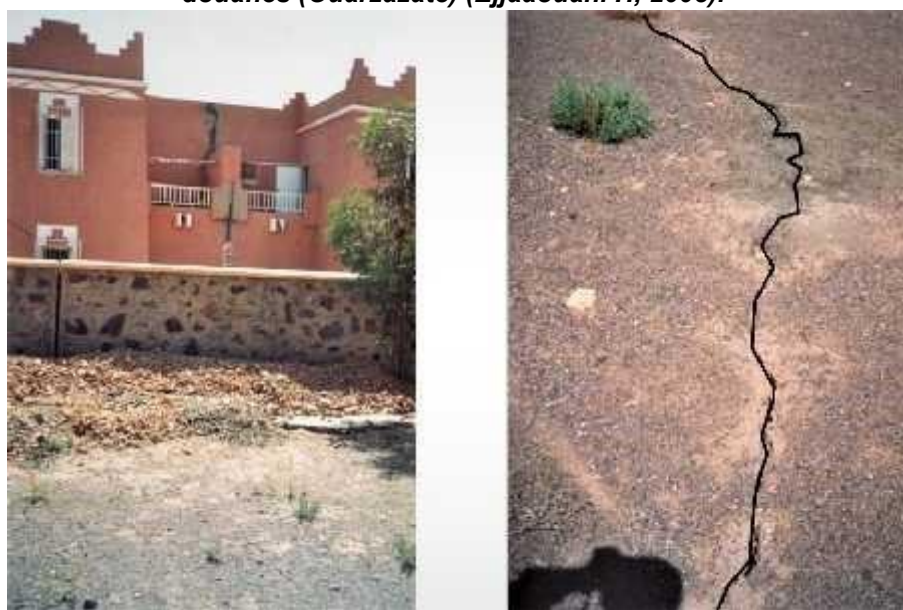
15 : Fissuration du bâtiment des douanes du fait de la migration de l'eau du collecteur d'eaux superficielles de l'ONEP (Ejjaouani H, 2008).
